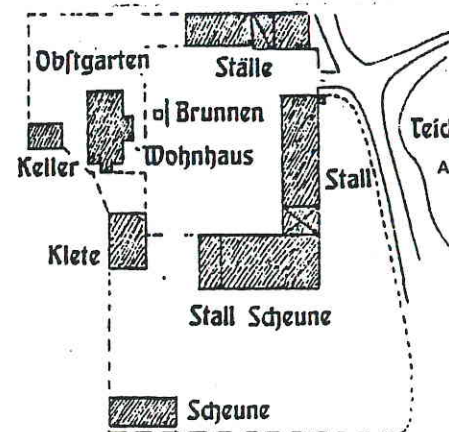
Lageplan des Hofes des Bauern Naujoks in Schnaugsten, Kreis Memel, mit Vielhausanlage
